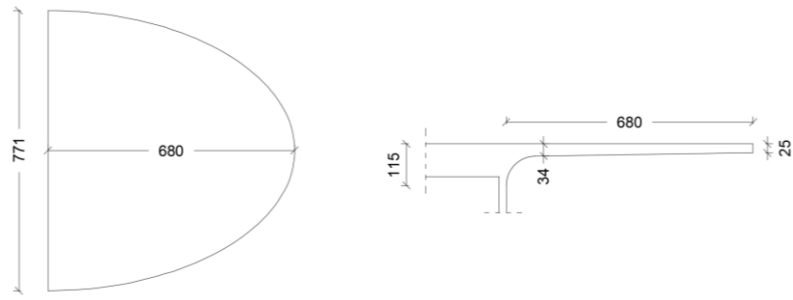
Pianta e sezione della pensilina semi-ellittica di Maratona
